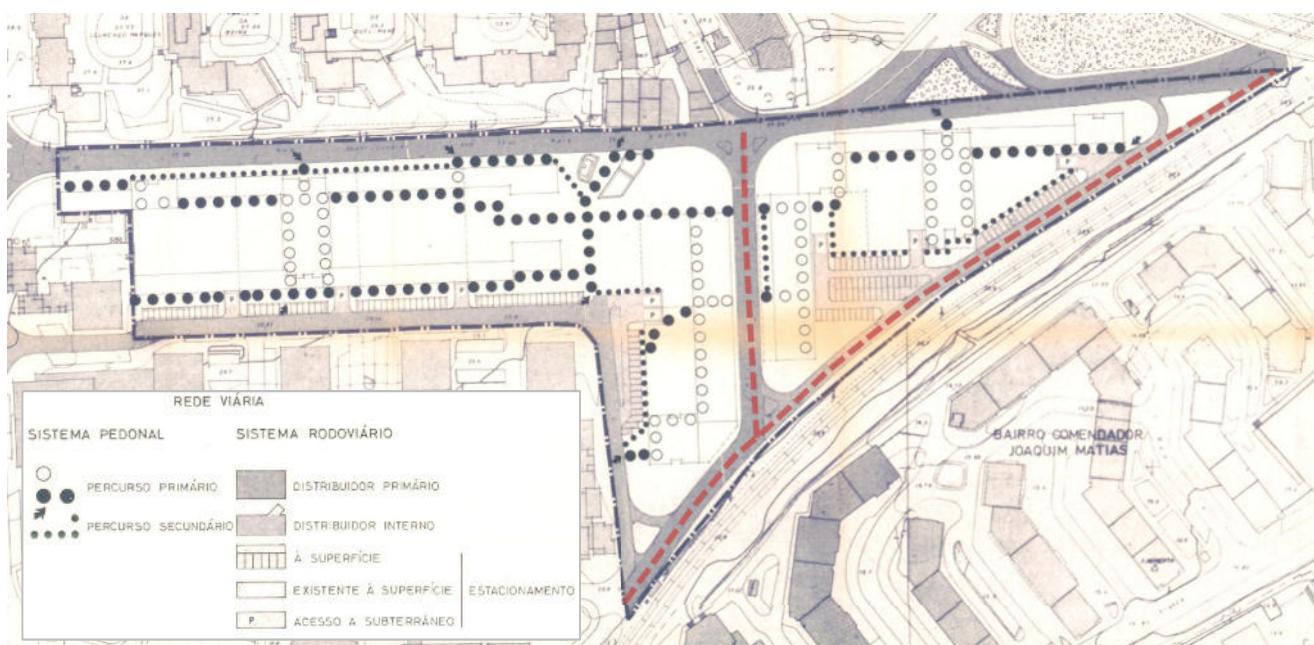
Anexo V - Levantamento - Operações de loteamento na área do PPE
